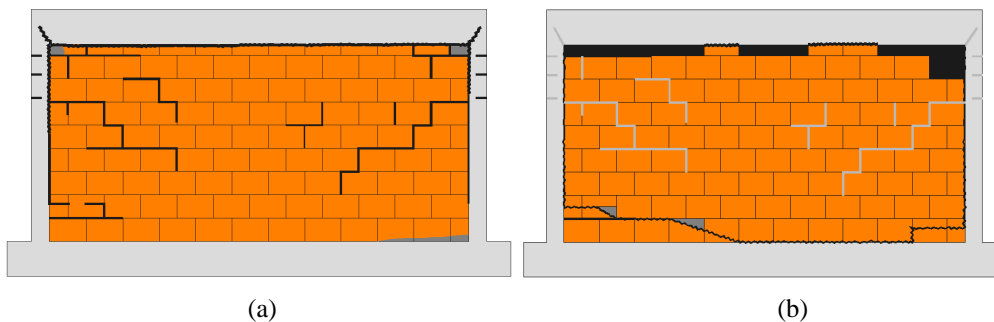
Fendas e dano para a parede de referência: (a) Após ensaio no plano; (b) Após ensaio fora do plano.
